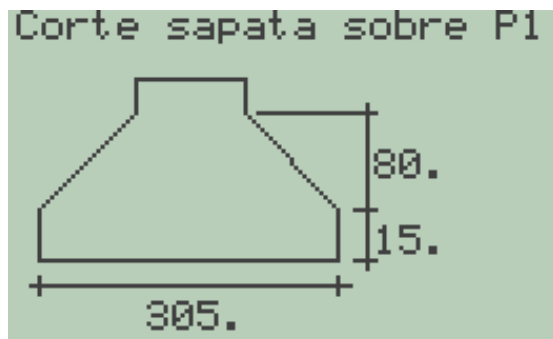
Viga alavanca - Detalhamento da seção transversal da sapata sobre P1.
